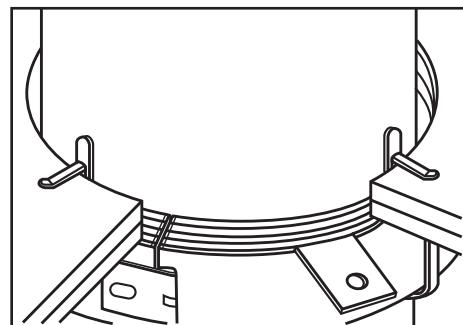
Vue en plan d'une courroie d'ancrage ultra rapide installée.
